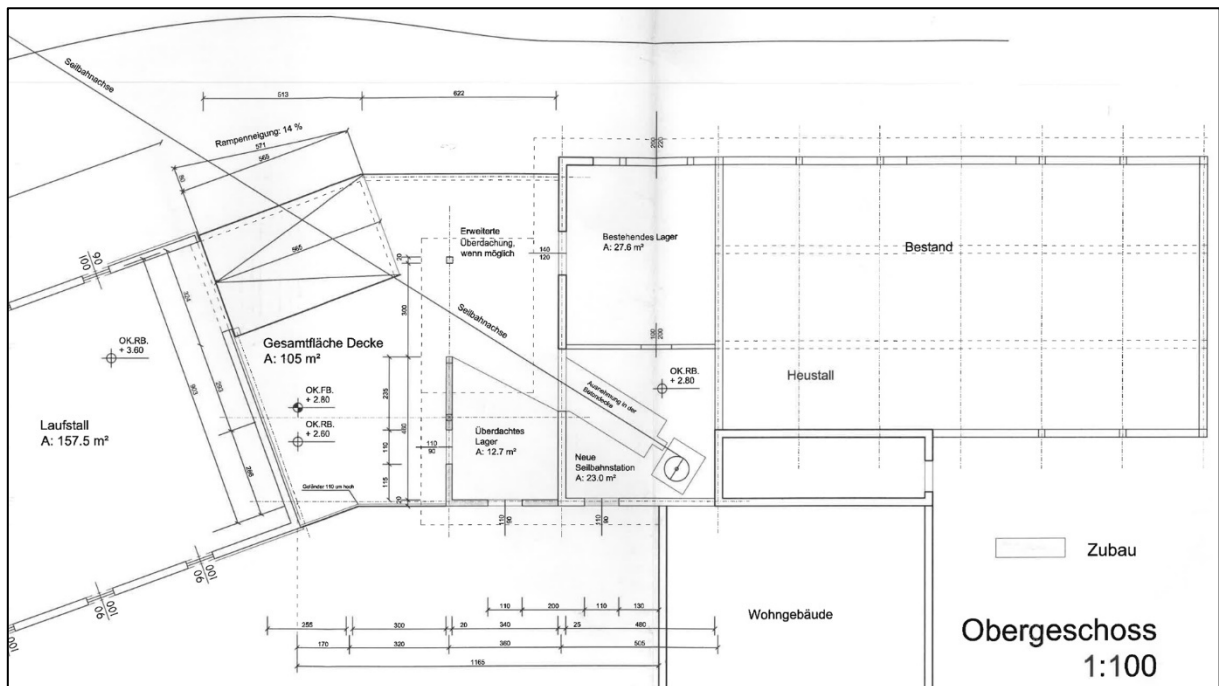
Einreichplan 2003; Grundriss des Obergeschoßes; das „bestehende Lager“ in der Bildmitte oben besitzt ein raumbreites Einfahrtstor mit Rollplane (vgl. Abb 94)
